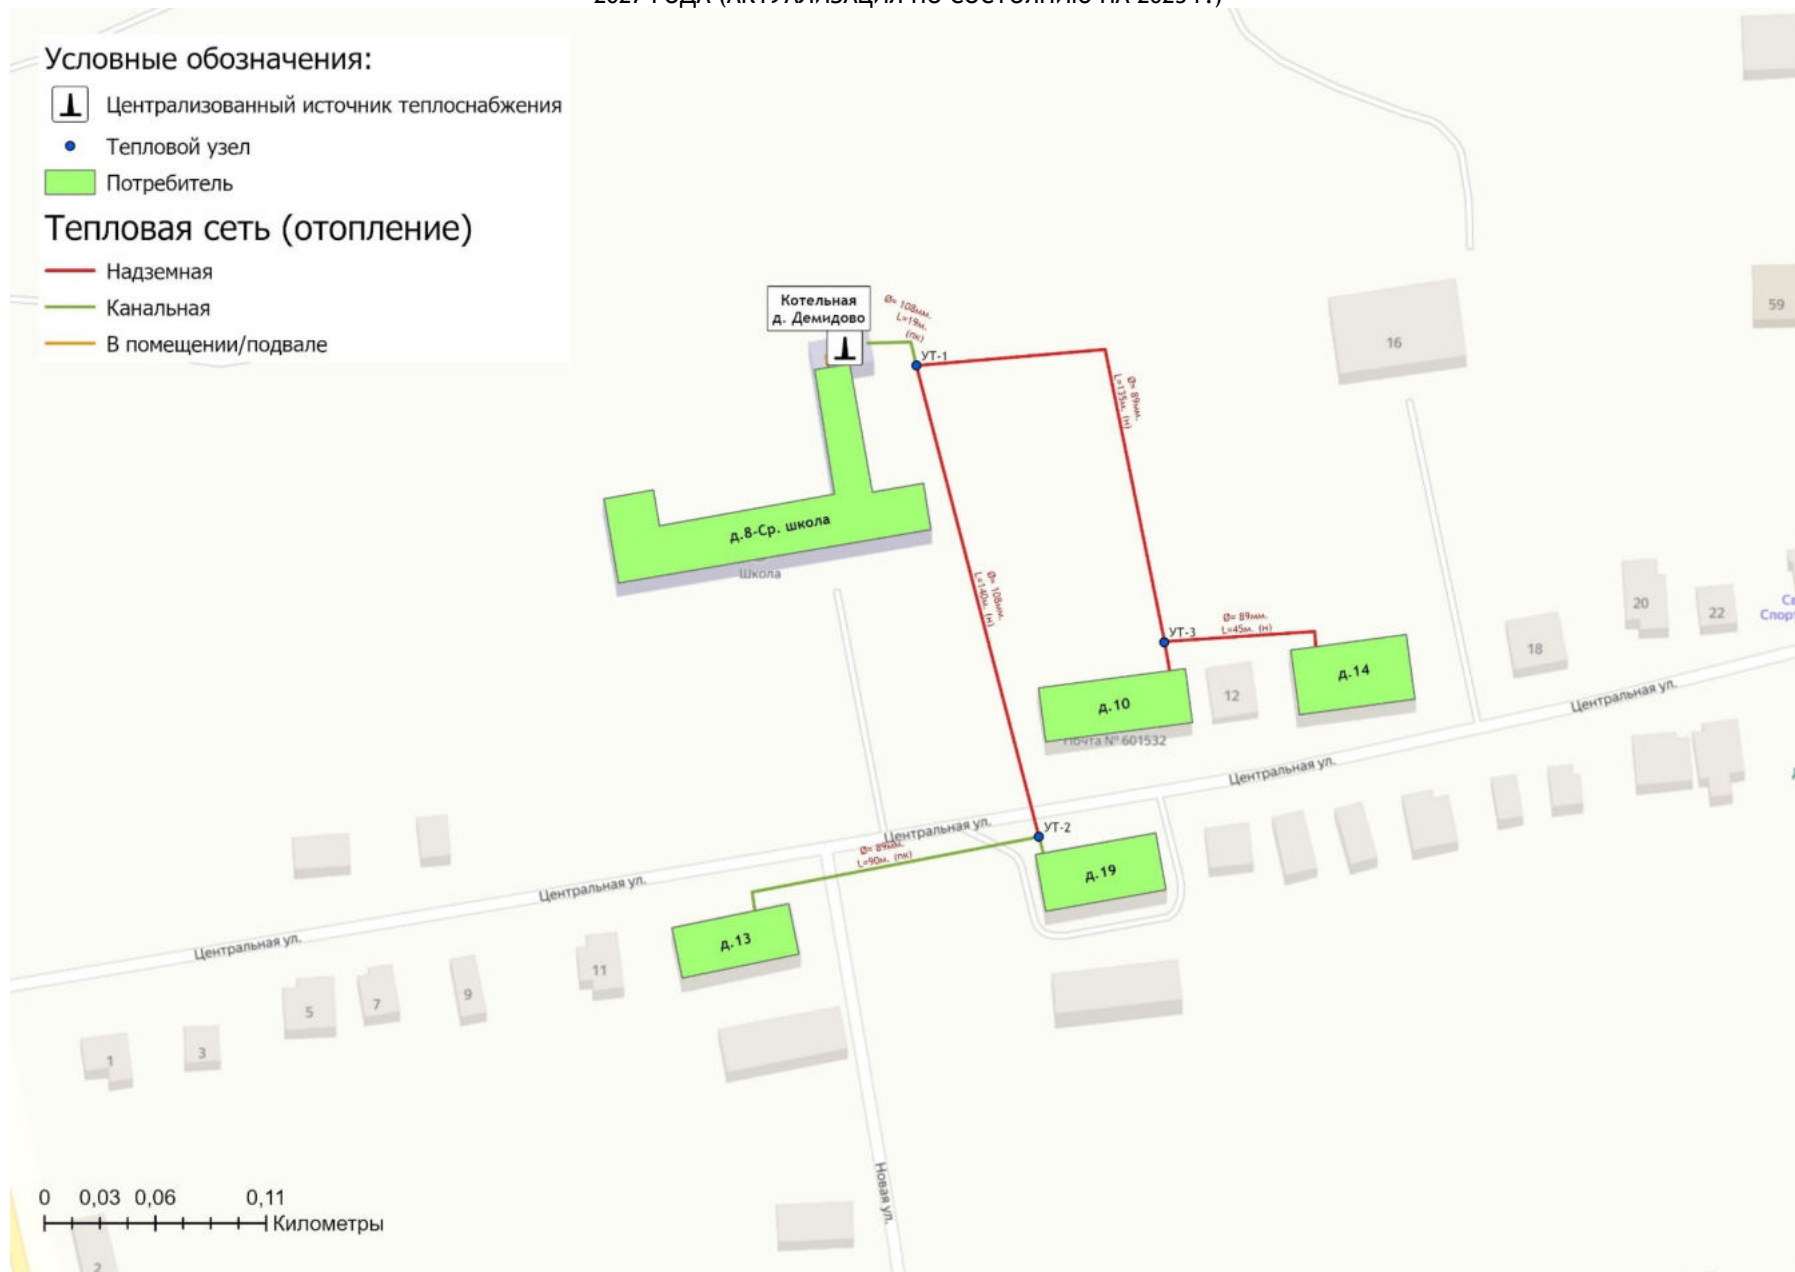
Схема тепловых сетей отопительной котельной д. Демидово
